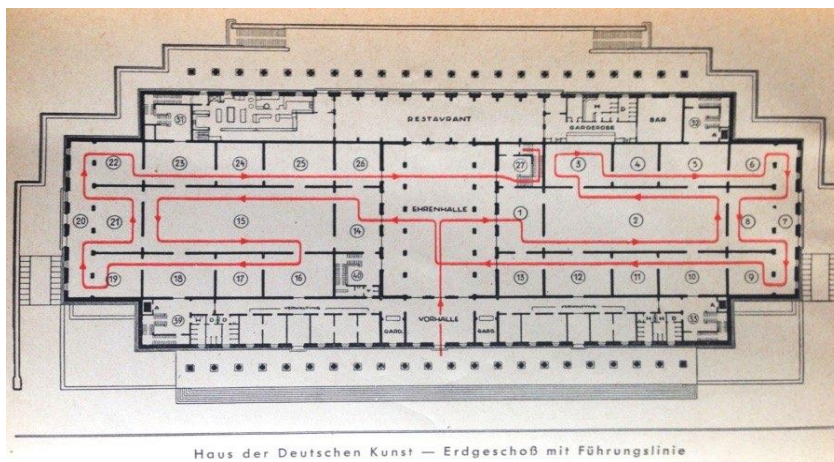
Grundriss des Erdgeschosses im HdDK mit der sogenannten Führungslinie
